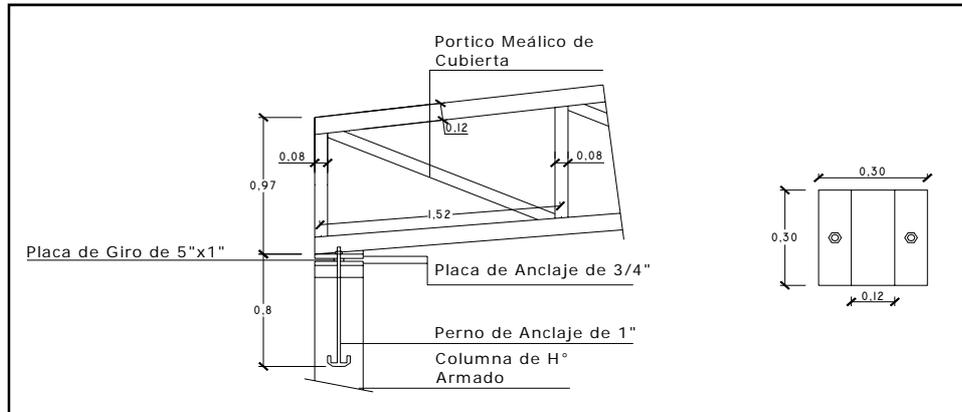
Vinculación de la estructura de cubierta con la estructura de hormigón
